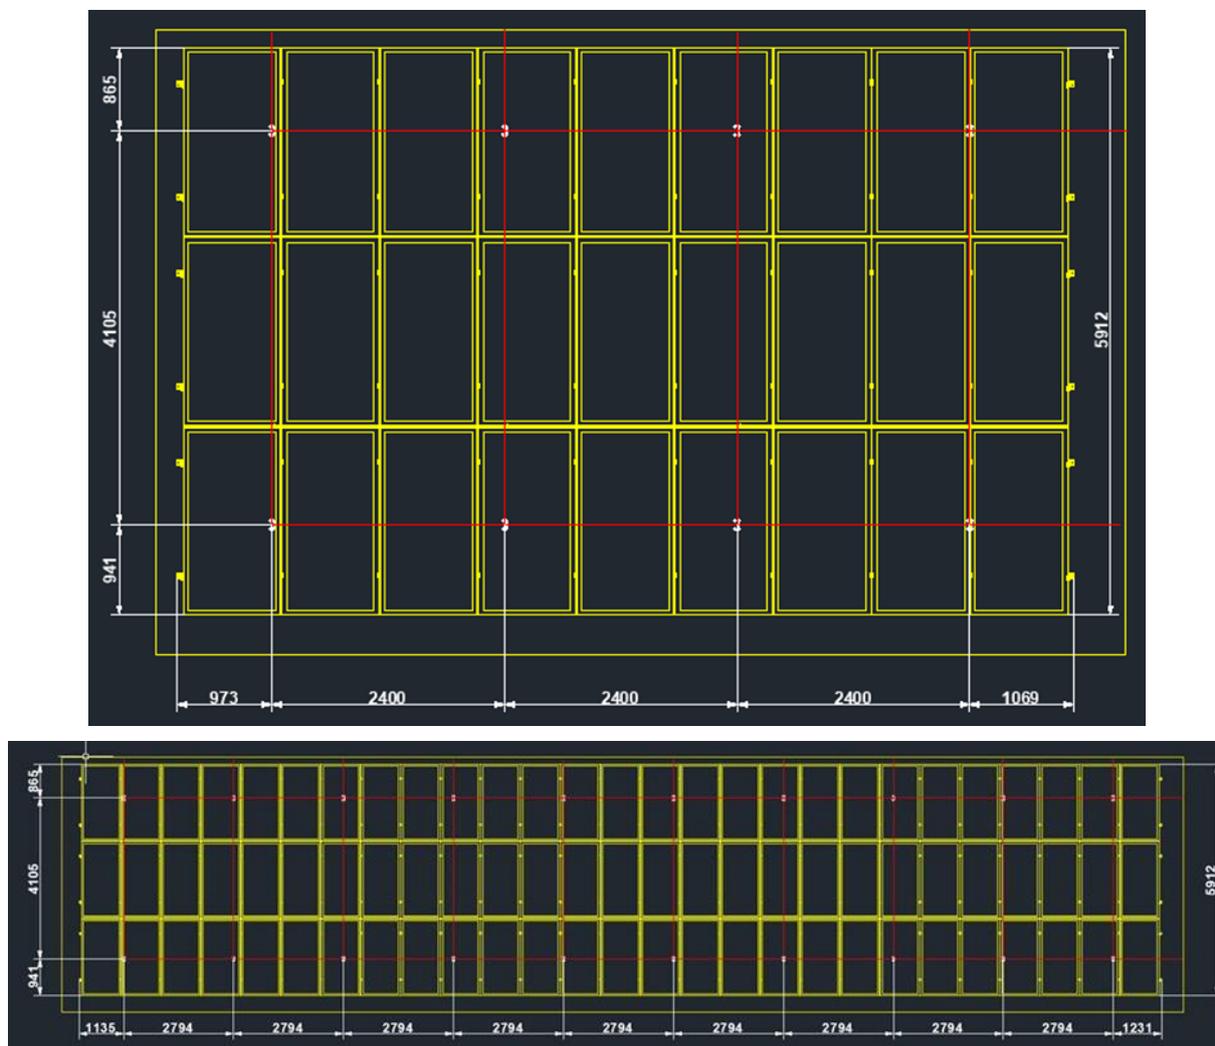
PV sol – vue en plan - espacement entre pieux pour les tables 3V9 et 3V27
